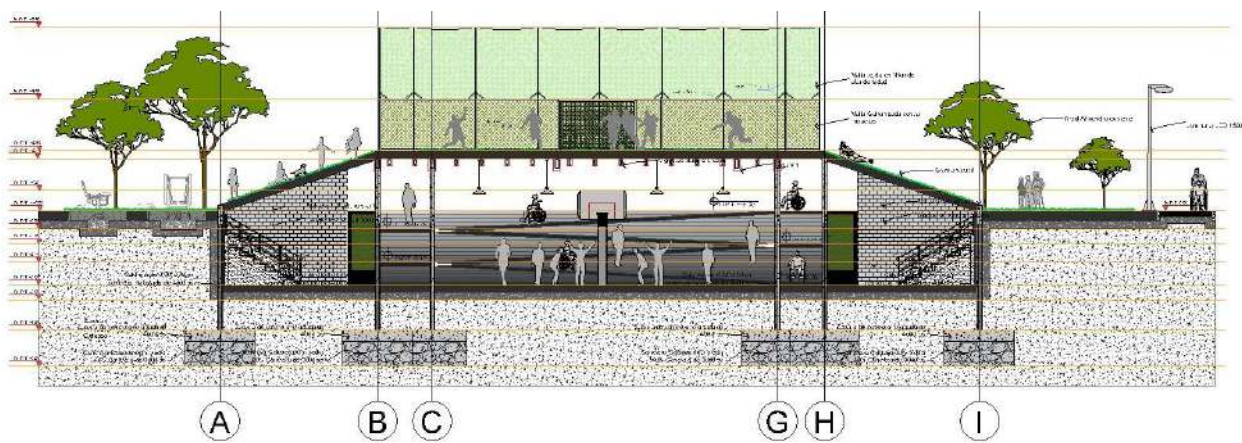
Sección arquitectónica, cancha baloncesto. Fuente: Elaboración propia 2021.
